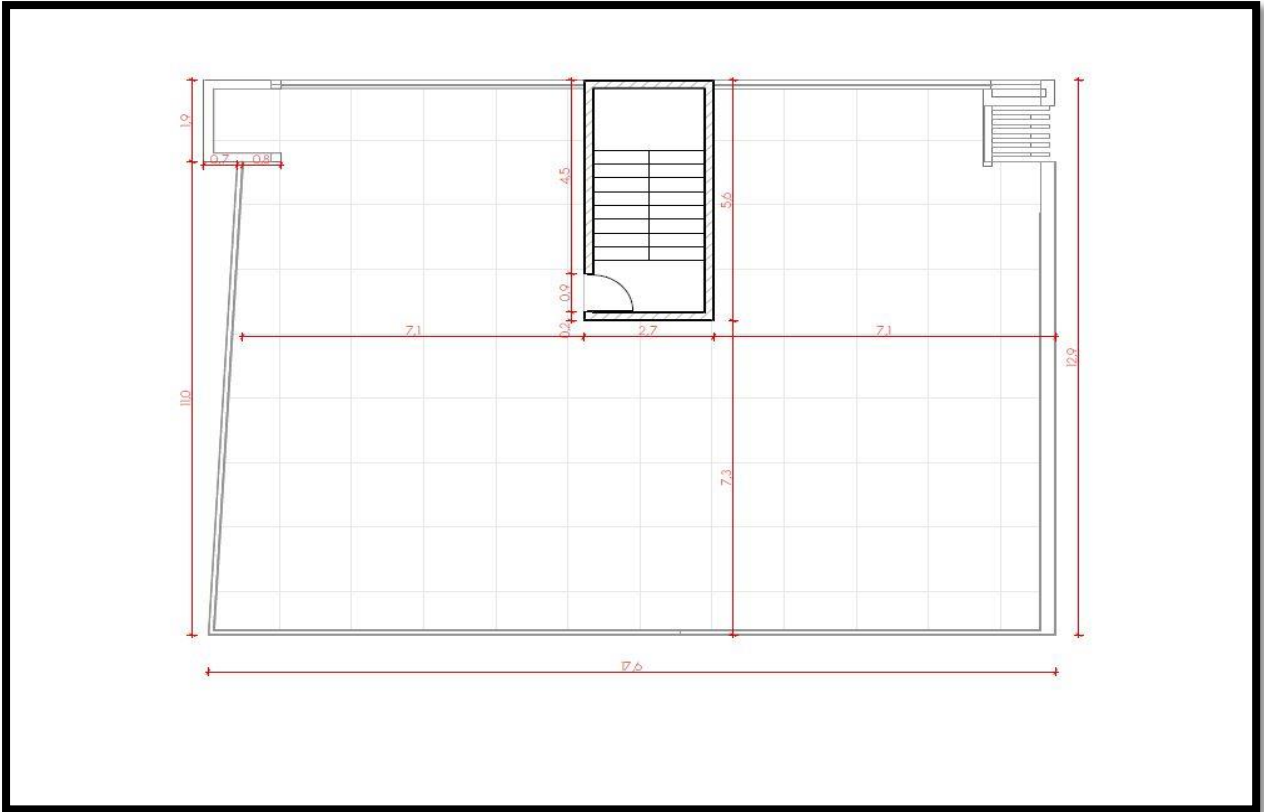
Planta de cobertura. (fonte: Golfo Engenharia e Construções, SA)
